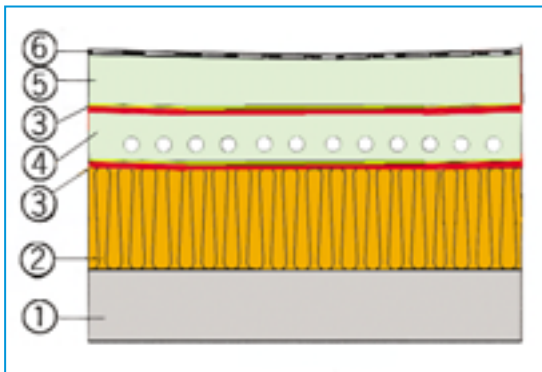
Bodenaufbau mit Abdichtung durch zwei Dichtungsbahnen:
